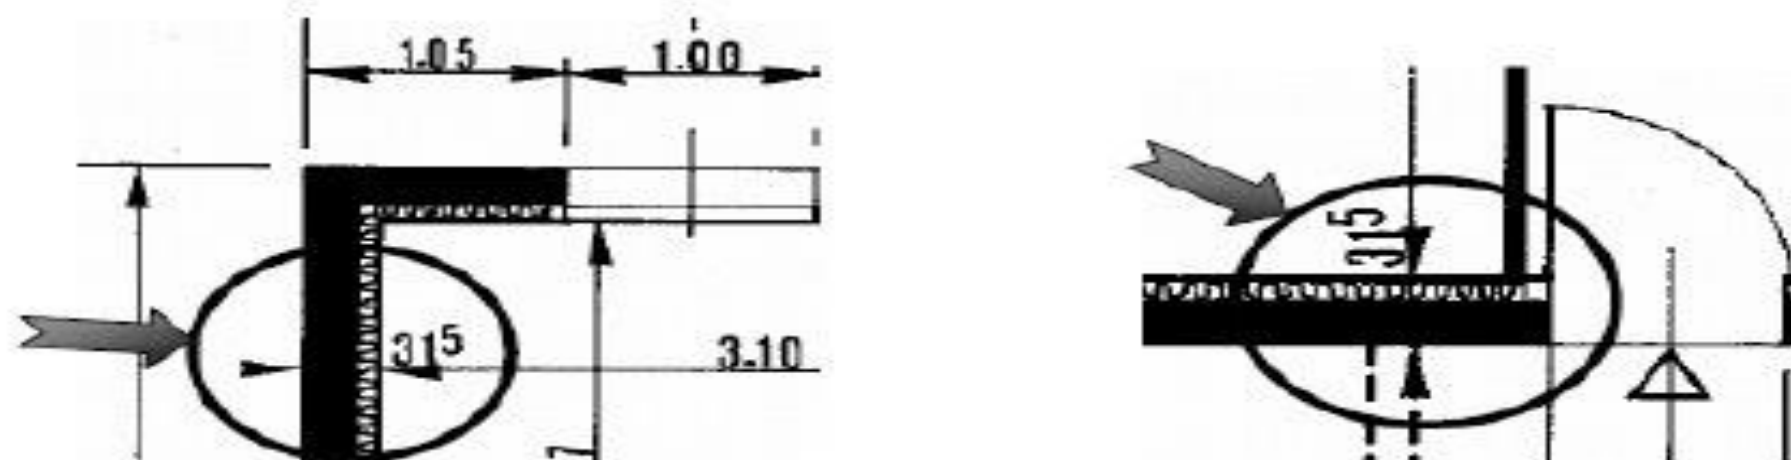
EXTRAITS DU PLAN DU REZ-DE-CHAUSSEE (Figure 8)
